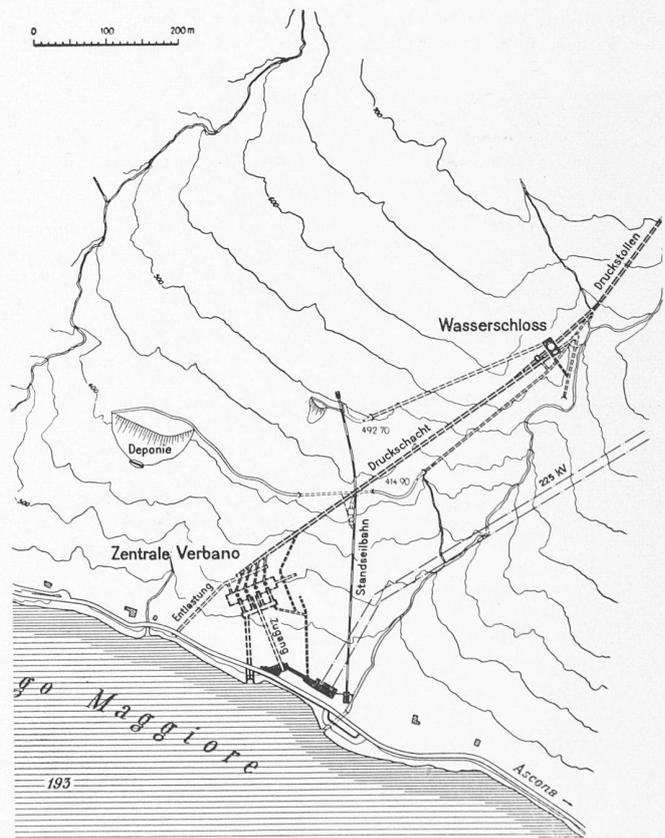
Wasserschloss, Druckschacht und Zentrale Verbano, Plan 1: 10 000
